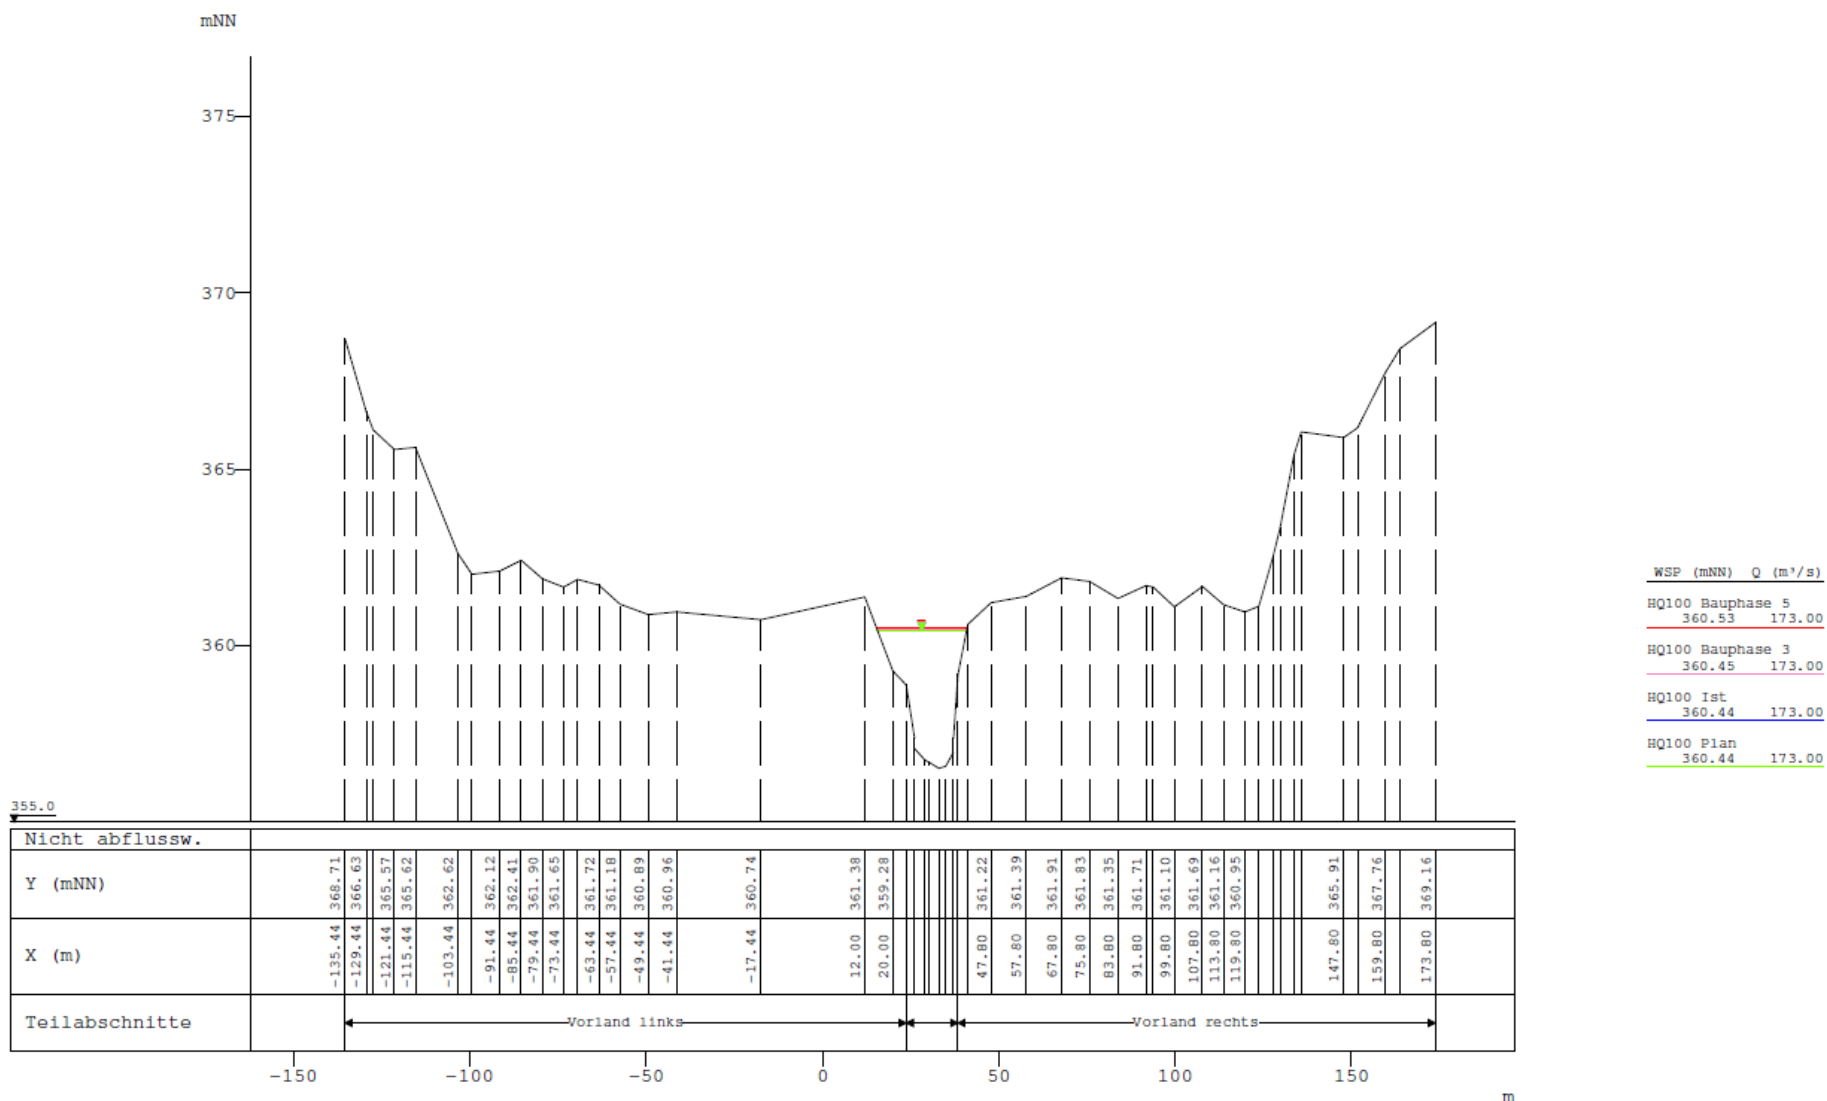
Querprofil 82223 (113 m im Oberwasser Brücke B410) inkl. Wasserspiegellagen HQ100 Istzustand, Planzustand, Bauphase 3 und Bauphase 5
